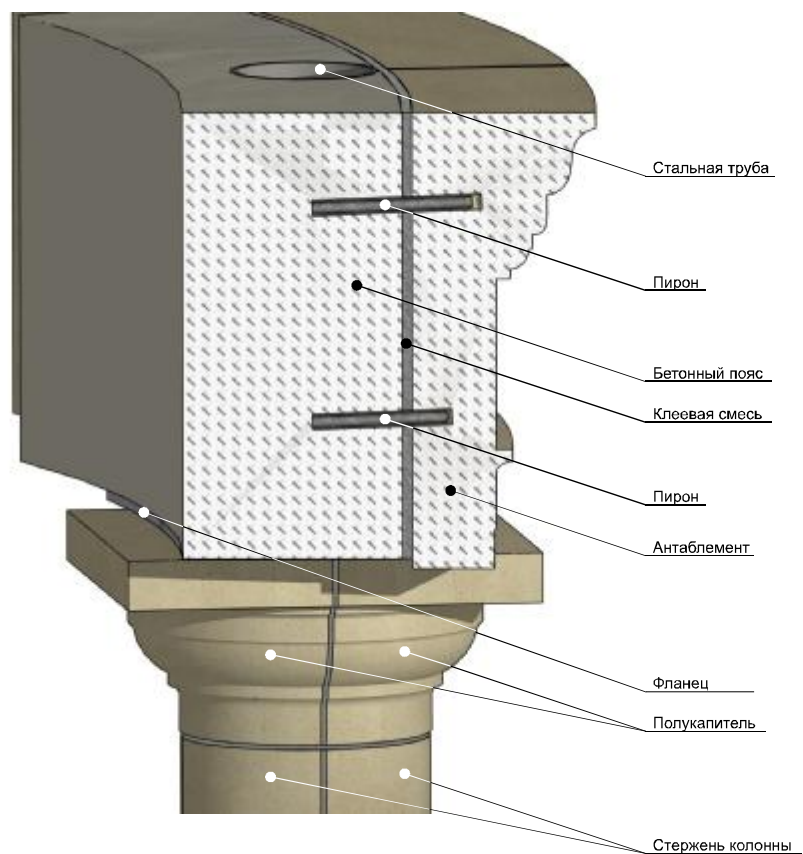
Схема монтажа антаблемента на бетонный пояс.
